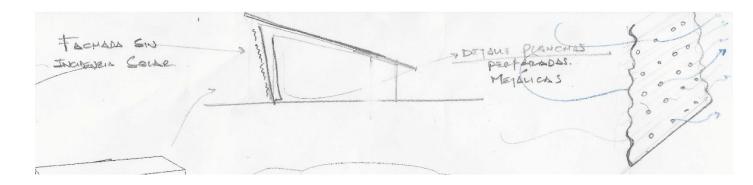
Partido Arquitectónico. Esquema de plano semi-abierto, plancha metálica perforada y aplicación sobre la fachada sur "sin incidencia solar"
